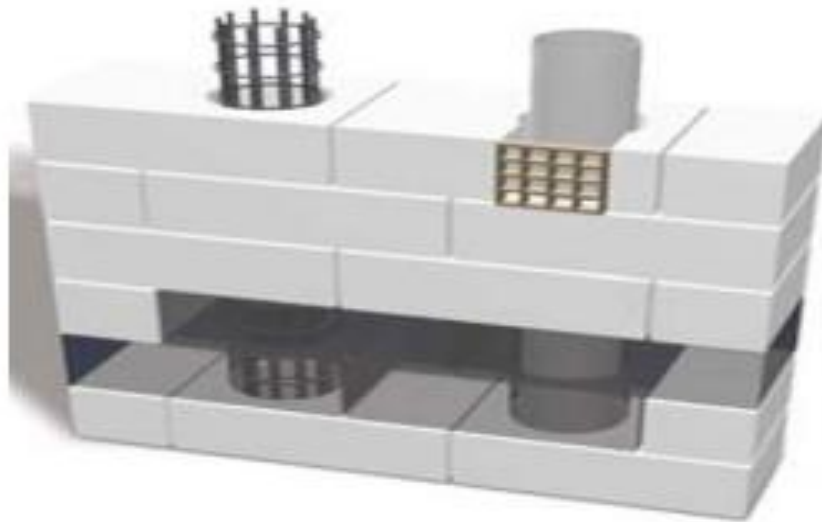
Принципова схема влаштування вертикальної залізобетонної колони та вентиляційного каналу в стіні з використанням газобетонних О-блоків.
